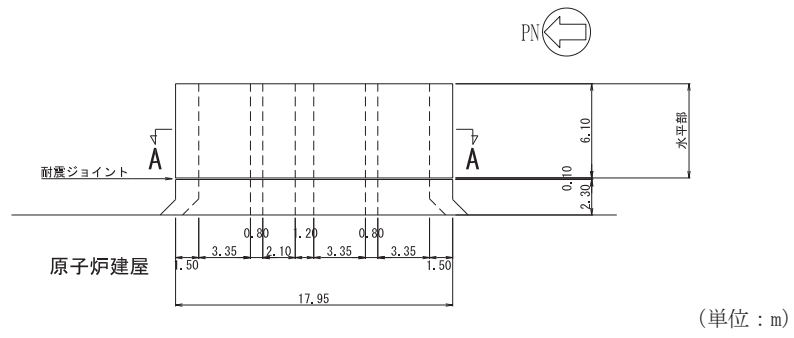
原子炉機器冷却海水配管ダクト（水平部）平面図
